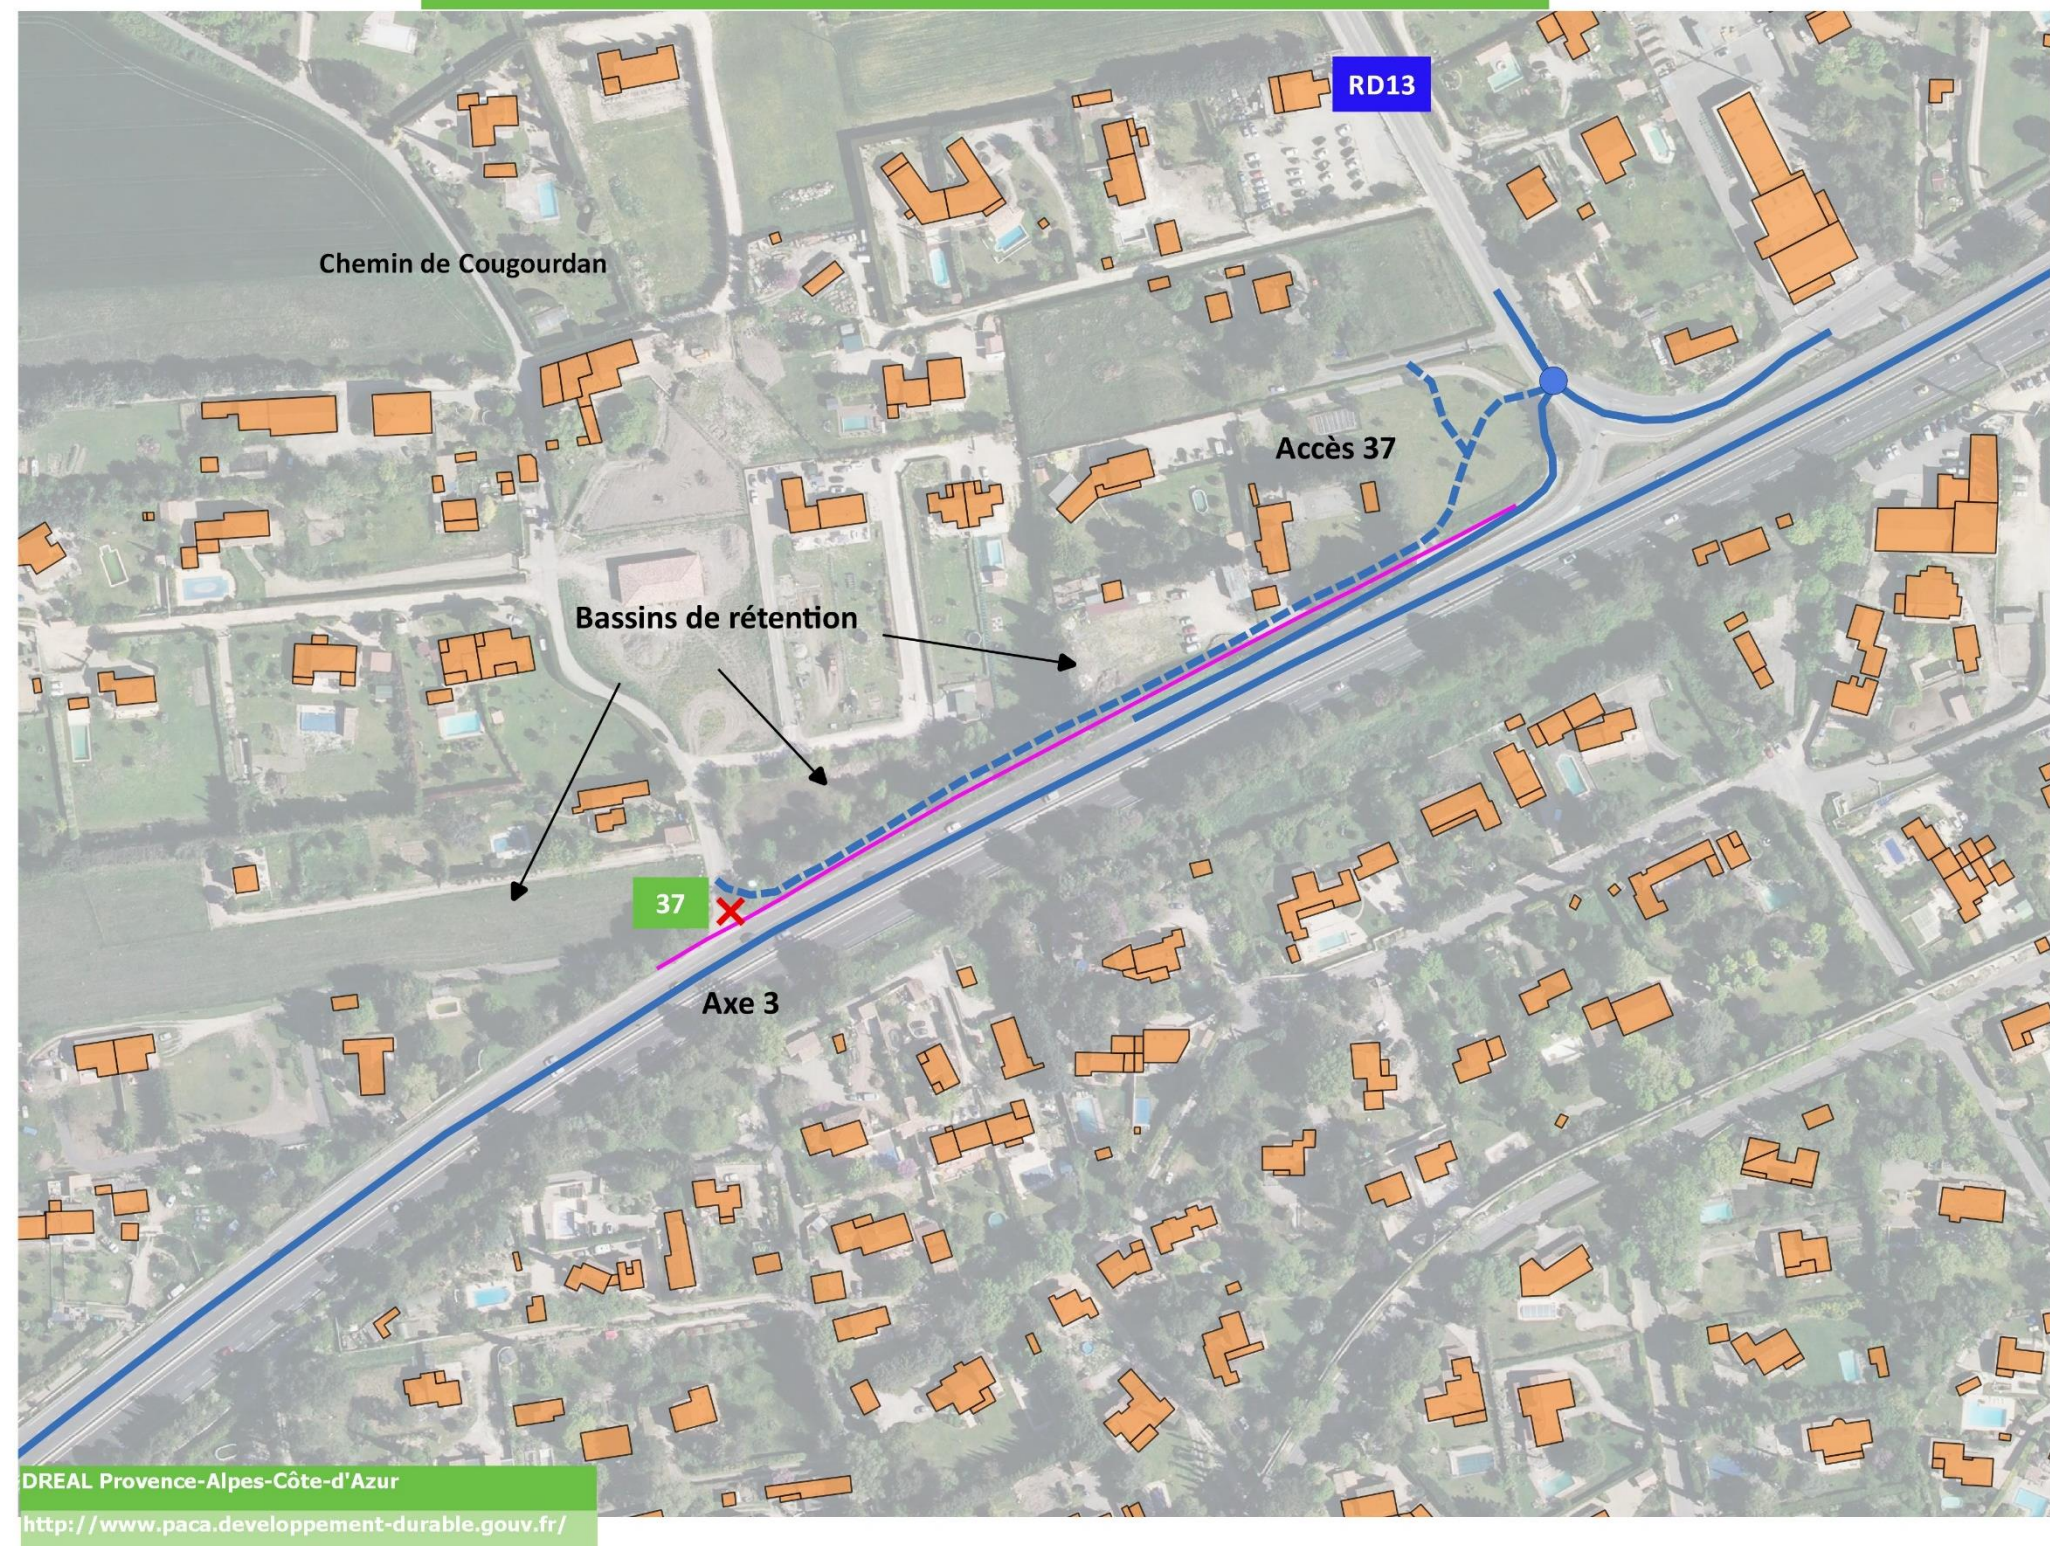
Plan des aménagements mis en œuvre pour l'accès 37
